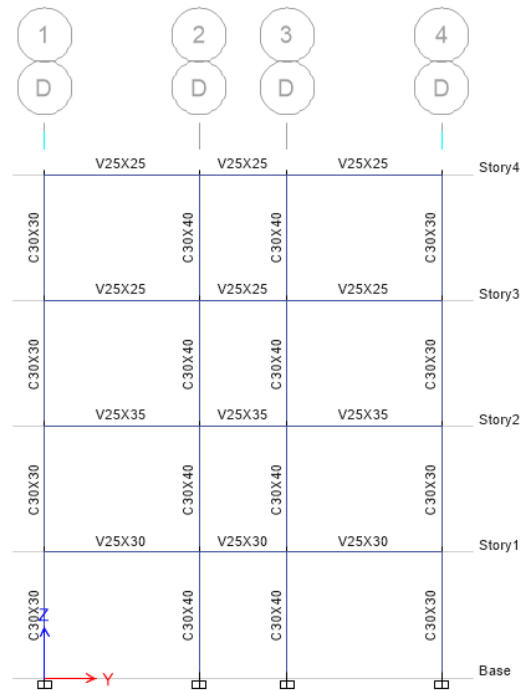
Vista de secciones en elevación pórticos A y J, para hormigón armado
